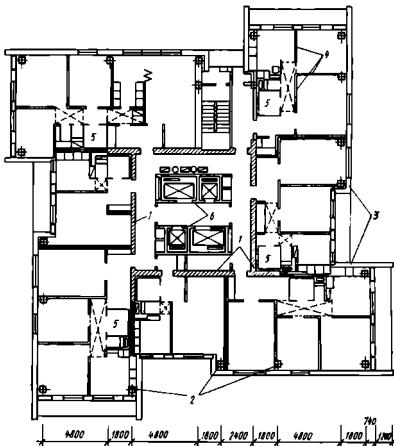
Каркасно-панельный 25-этажный жилой дом с монолитным ядром жесткости. План типового этажа:
